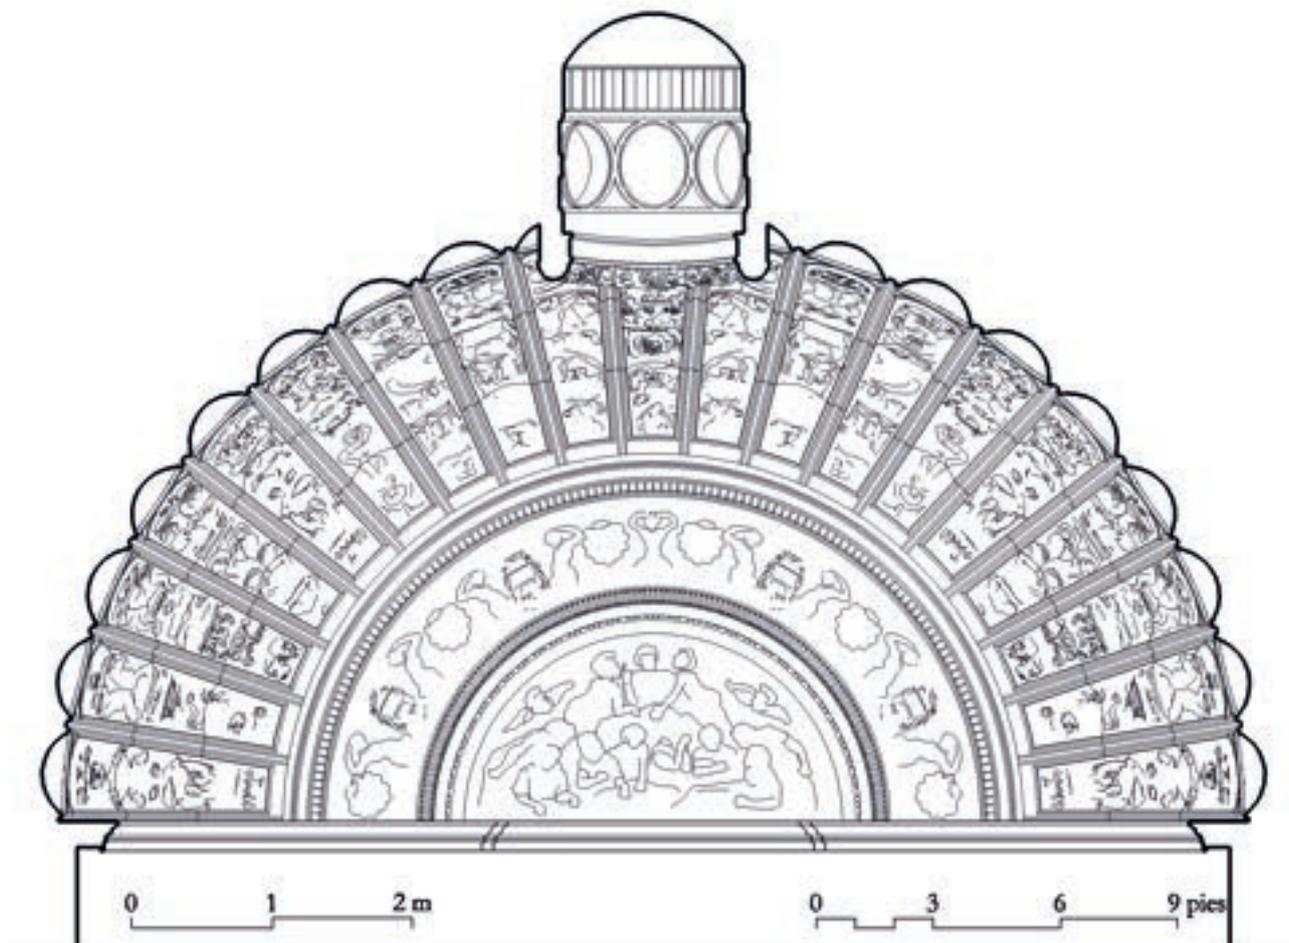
Sección longitudinal de la bóveda de la capilla de Gil Rodríguez de Junterón en la catedral de Murcia. Attr. J. Torni y J. Quijano, 1525- 1543. Levantamiento de M. Alonso y A. López Mozo
